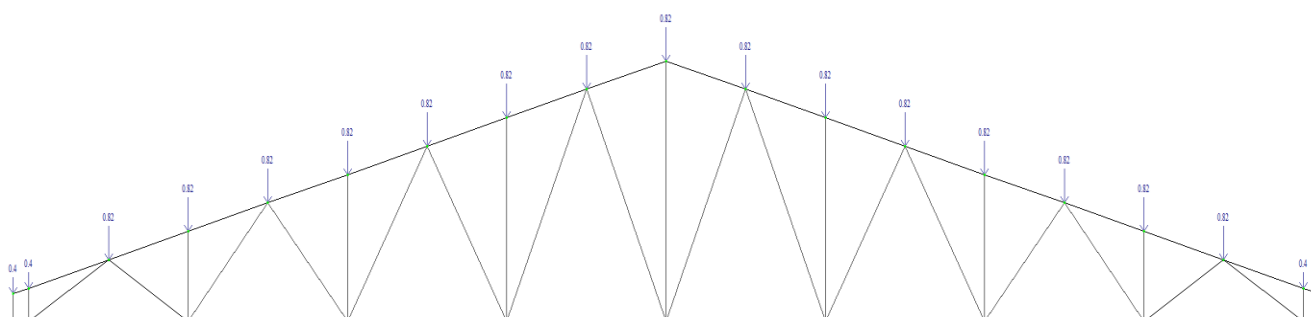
Схема снігового навантаження (загрузка 3)
